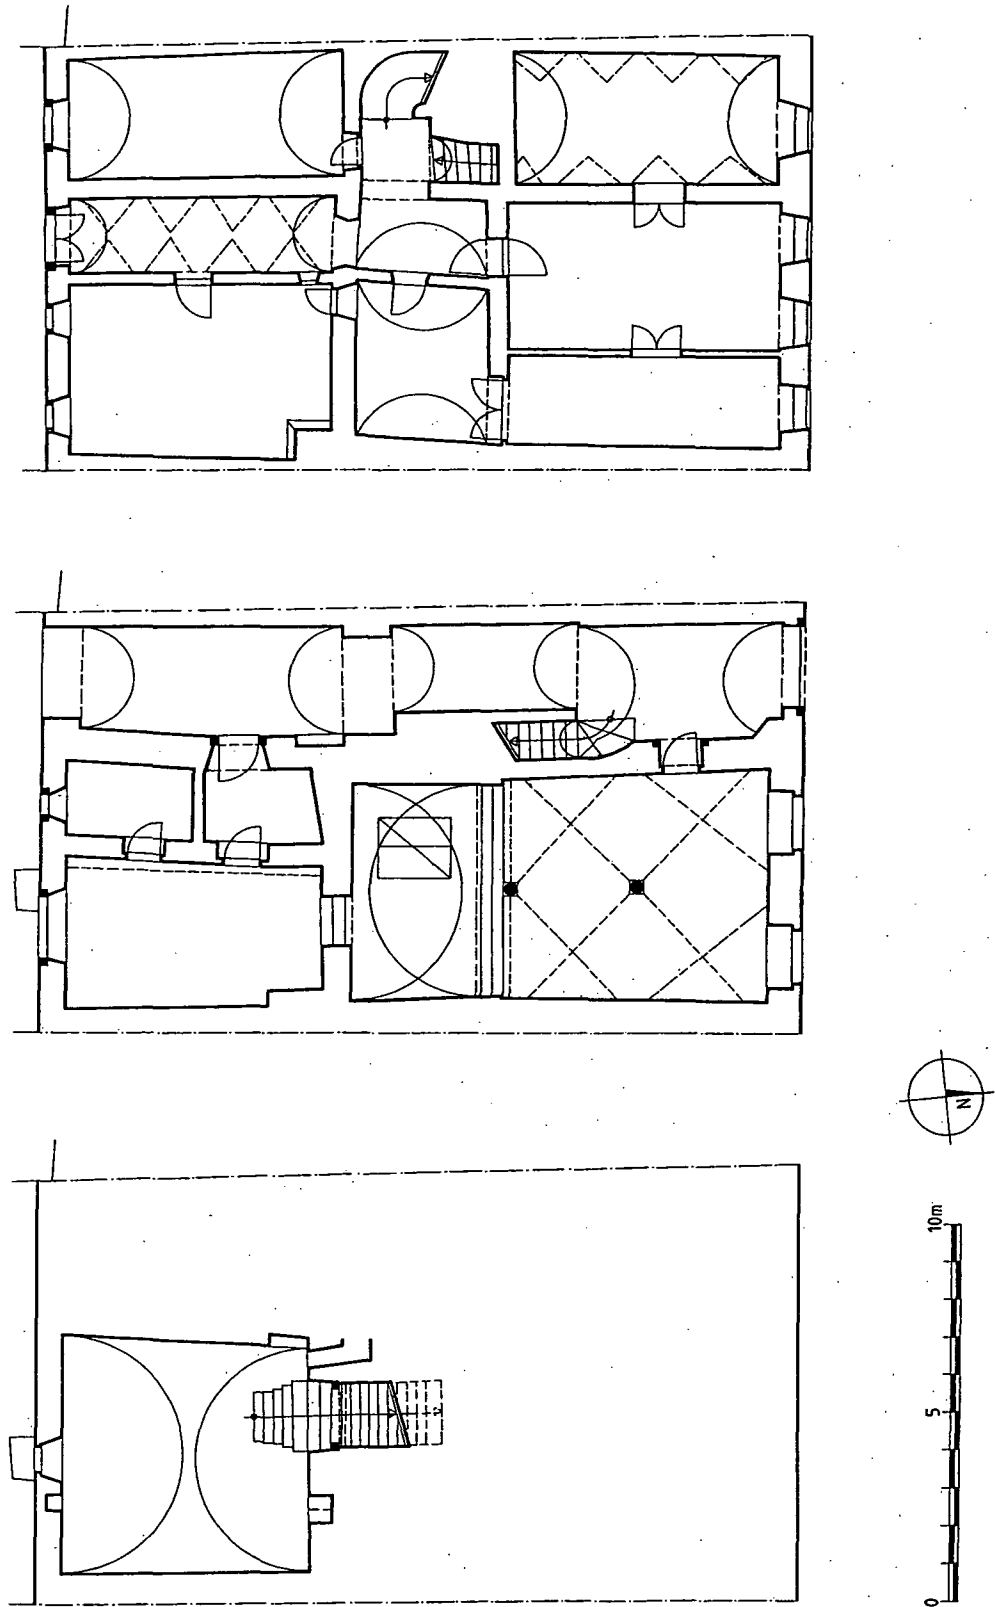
Stadtplatz 19 – Grundrisse Keller, Erdgeschoss, Obergeschoss (1:200).
